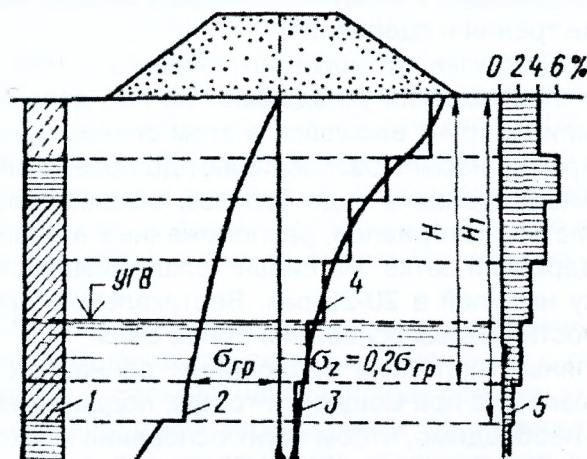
Расчетная схема вычисления осадки от сжатия грунта под насыпью: 1 – геологический разрез; 2 – кривая напряжений от собственного веса грунта; 3 – кривая напряжений от веса насыпи; 4 – замена кривой напряжений ступенчатой эпюрой; 5 – эпюра относительного сжатия грунта; H – первоначальная толщина сжимаемой толщи; H_1 – толщина сжимаемой толщи, уточненная с учетом уплотнения расположенных ниже слоев грунта
